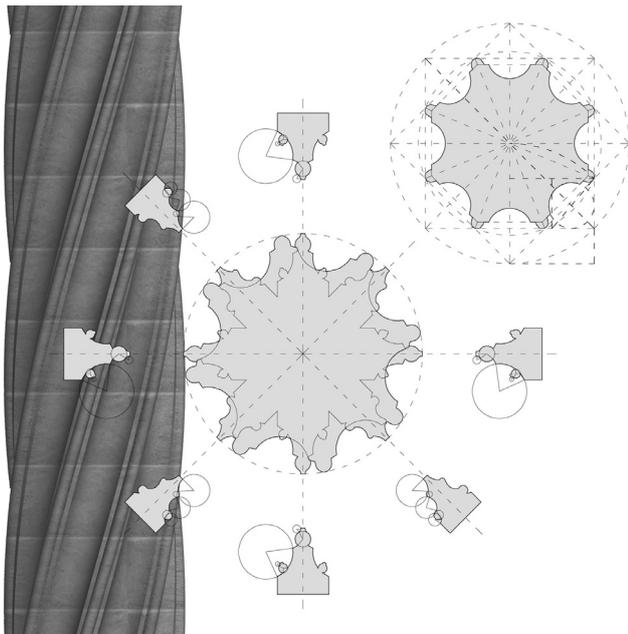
Salón columnario. Plantillas de los jarjamentos y pilar torso
